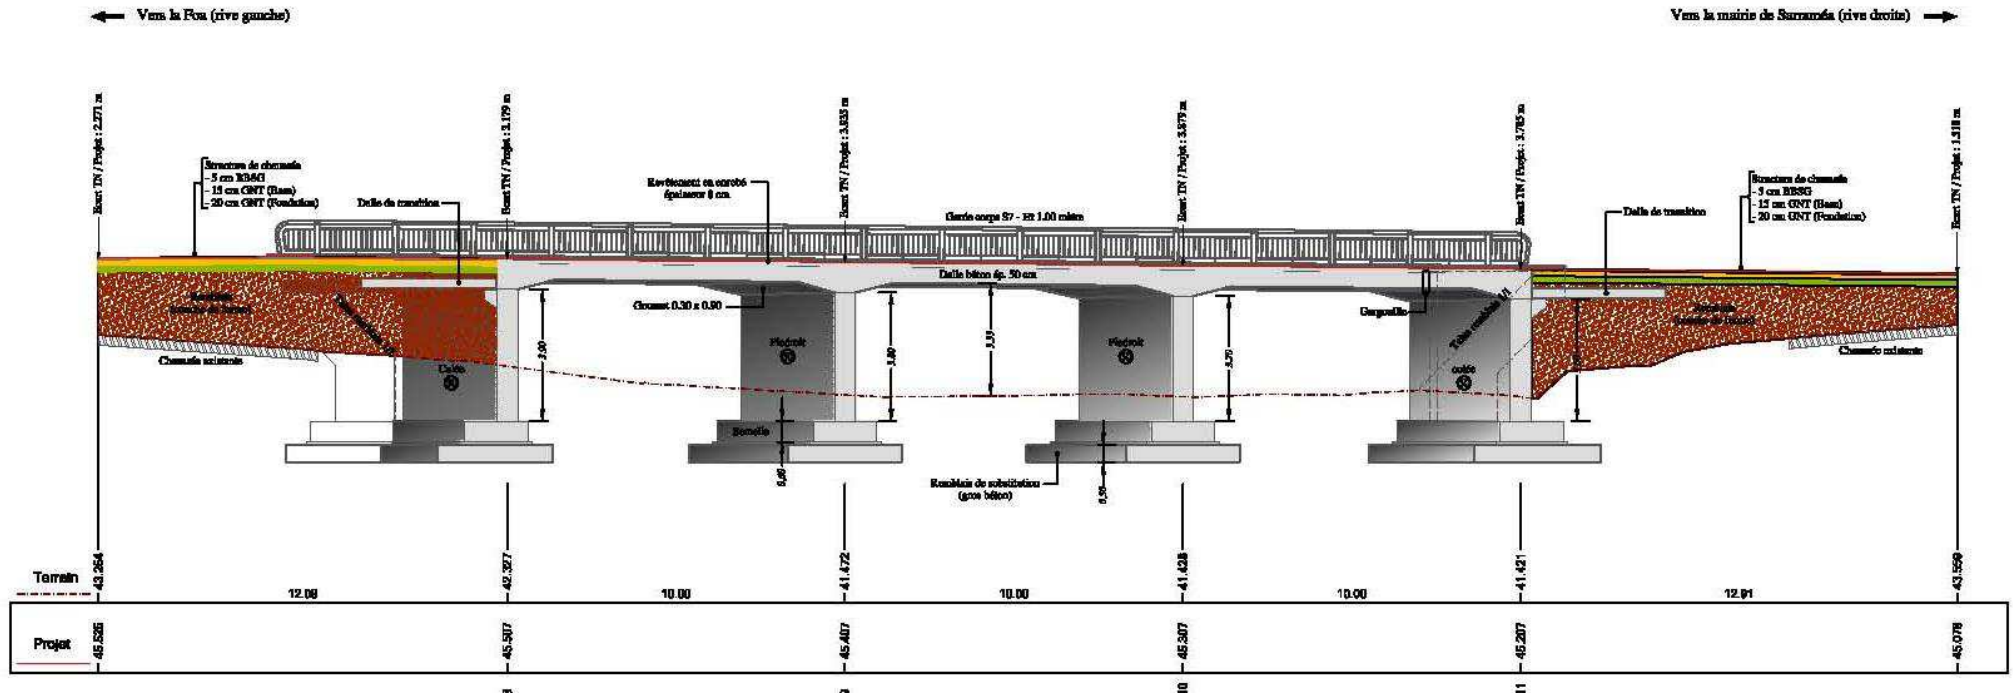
coupe longitudinale à l'axe de l'ouvrage
